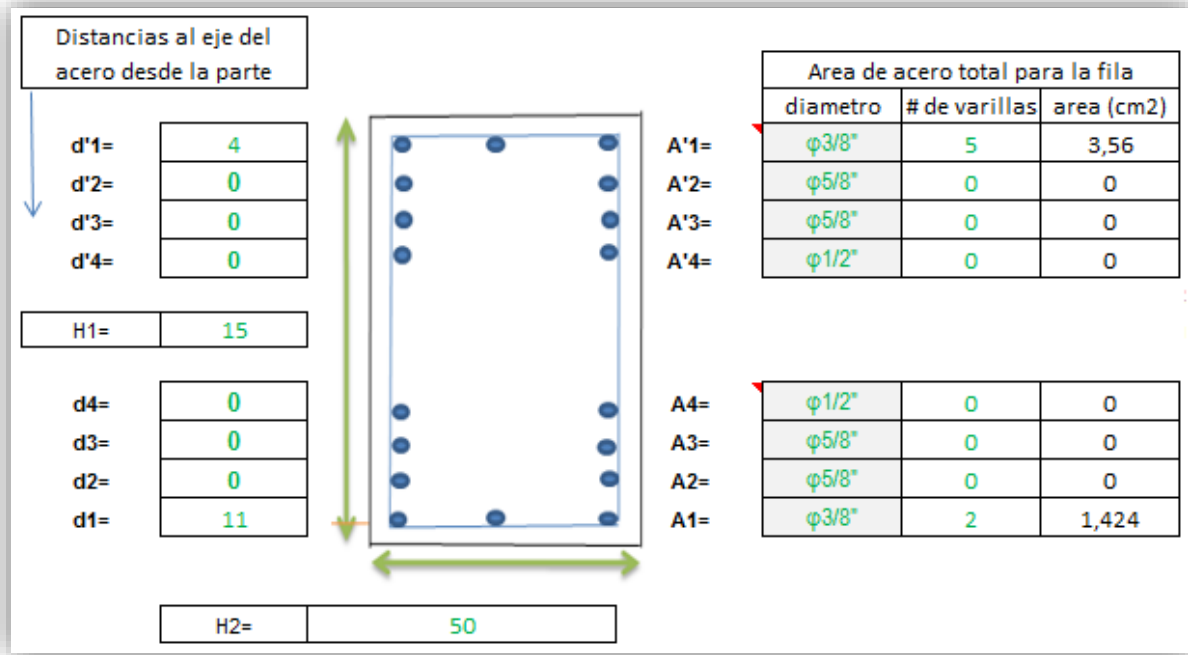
Acero de refuerzo en la escalera 1
